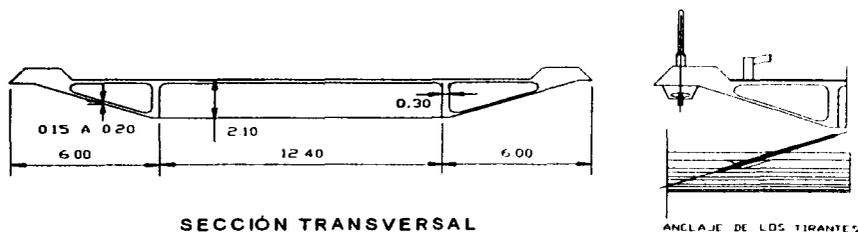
Sección transversal del puente Pasco – Kennewick para un claro de 300 m
